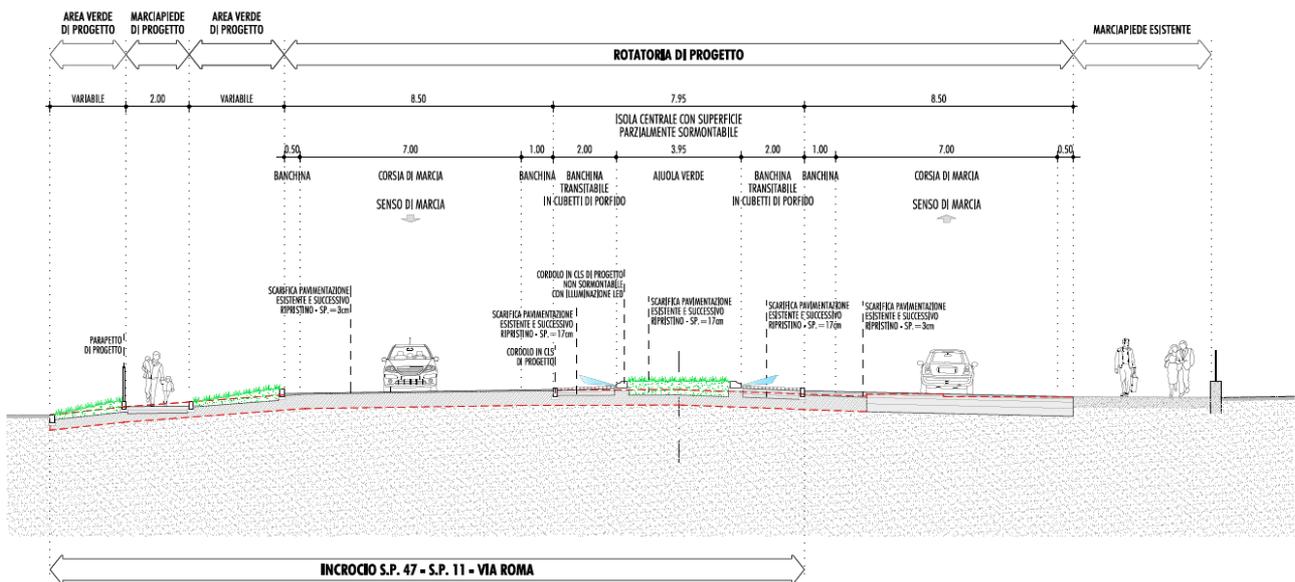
INTERSEZIONE S.P. N° 11 – VIA ROMA: SEZIONE TRASVERSALE TIPO
